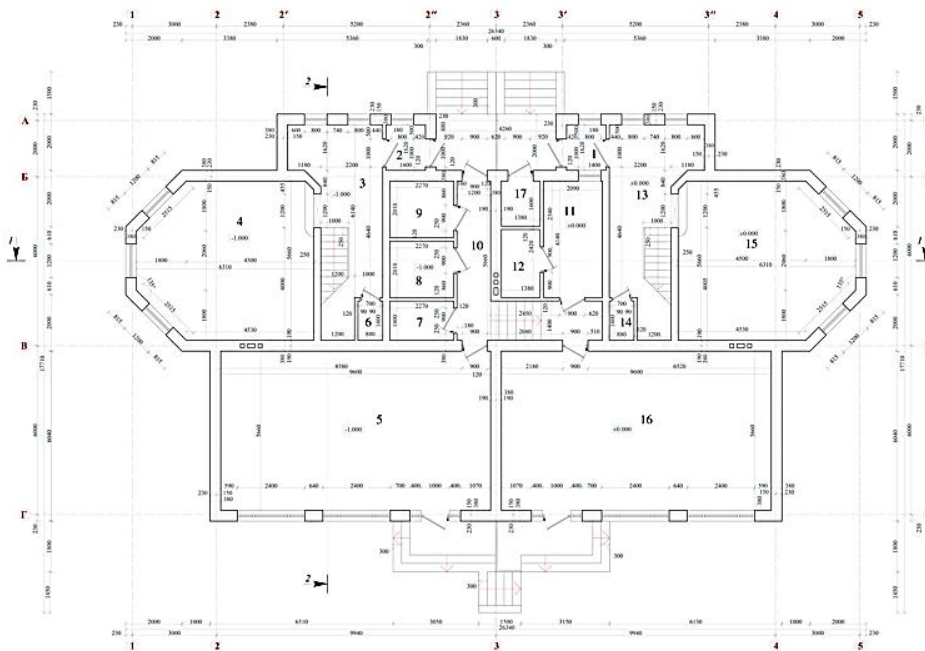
План першого поверху на відмітках 0,000 і -1,000. М 1:50.
